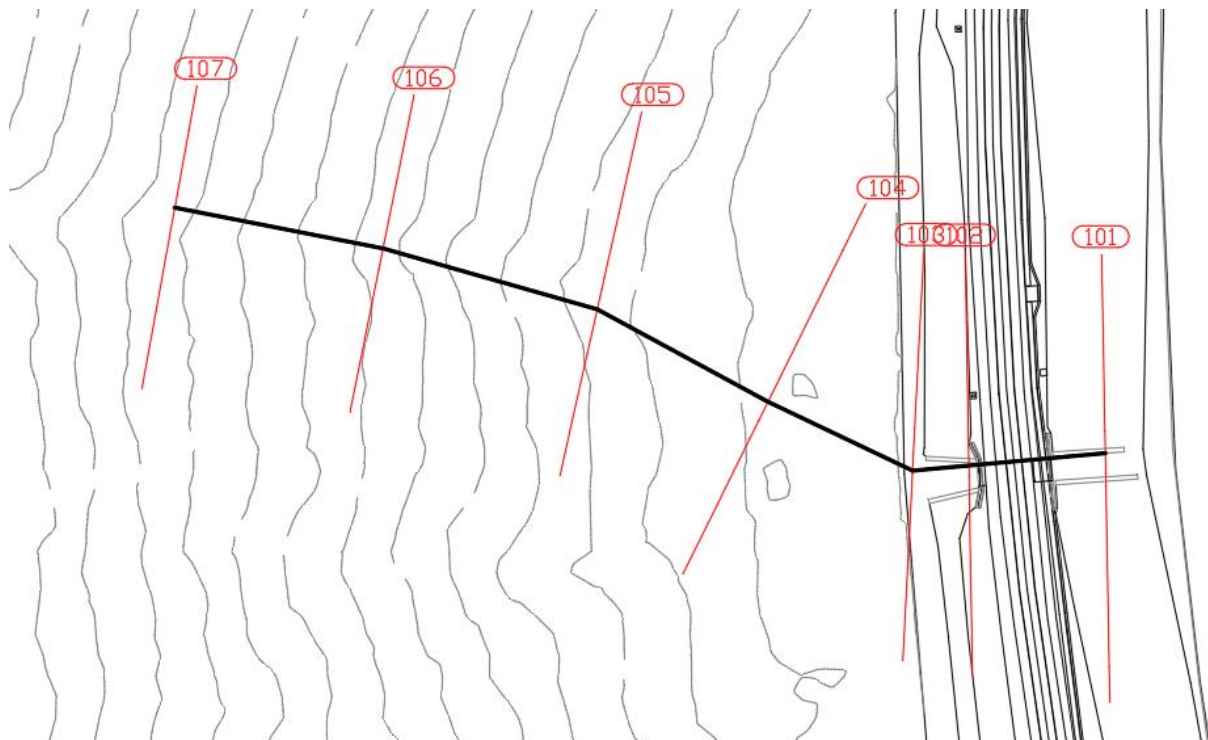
Schema planimetrico dell'asse IN01 e delle sezioni trasversali in condizioni Ante Operam
